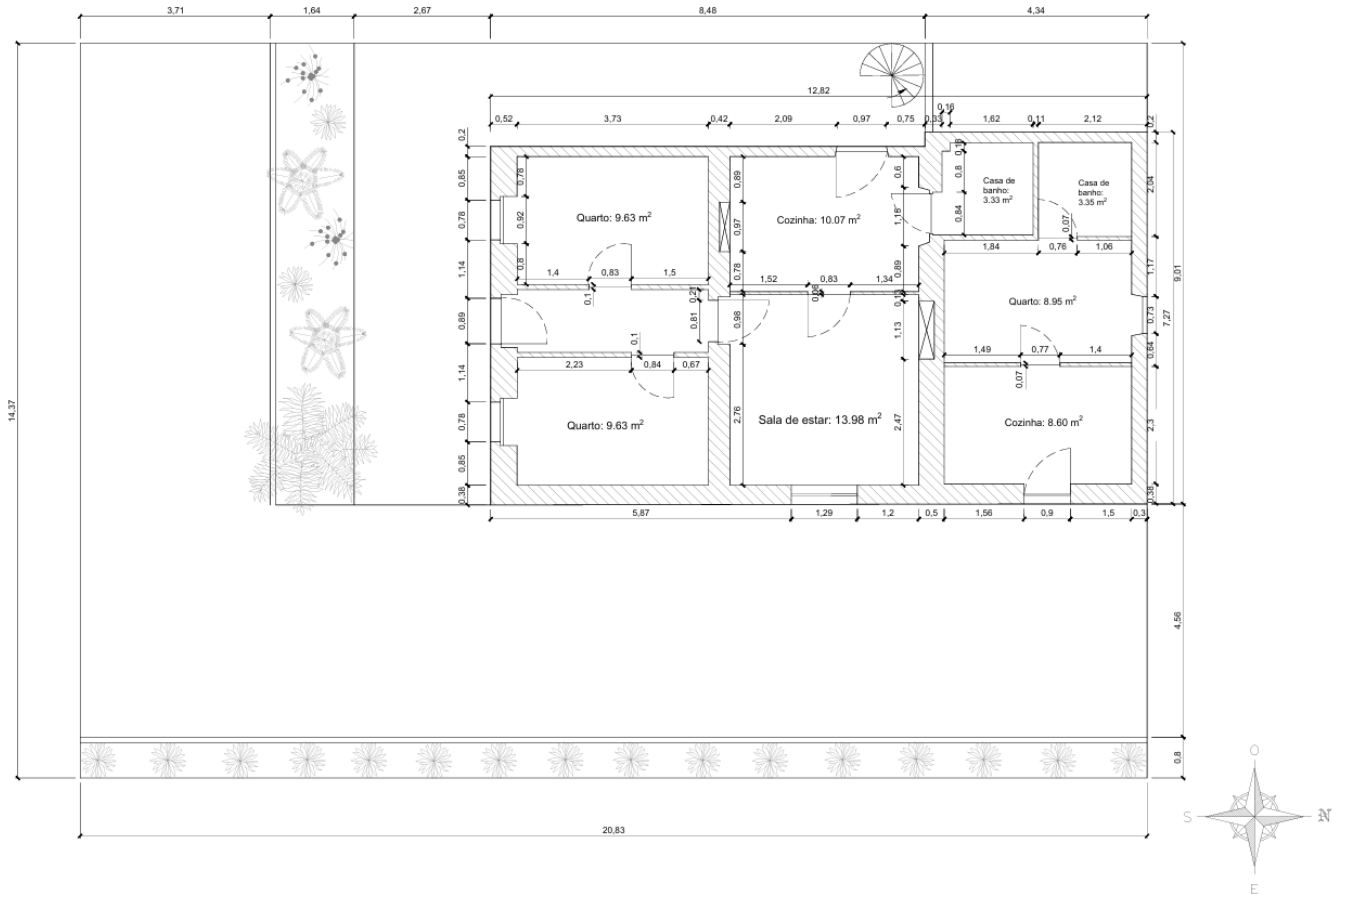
Planta existente (Fonte: Rita Giro, 2025)
